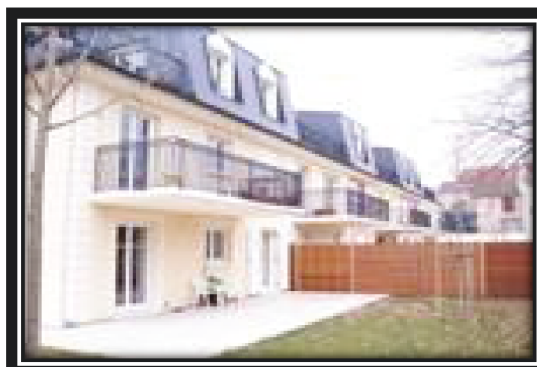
construction de 17 logements et bureaux 94120 FONTENAY S/BOIS
